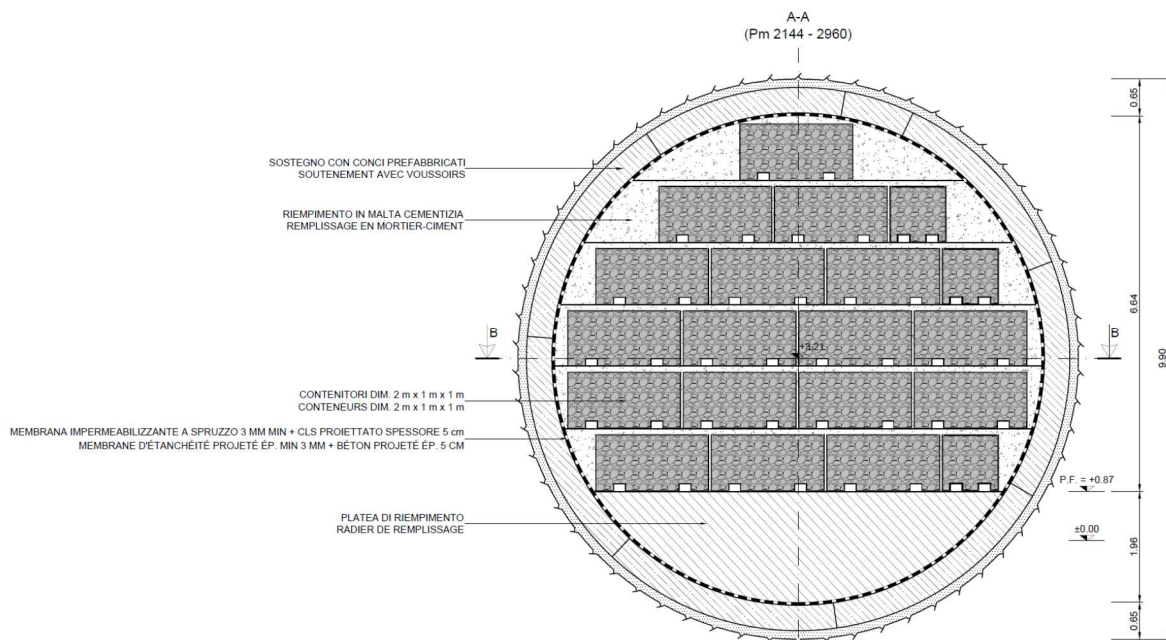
Sezione di stoccaggio nella sezione corrente di Maddalena 2 (PRV_C3A_7533_26-48-11)
